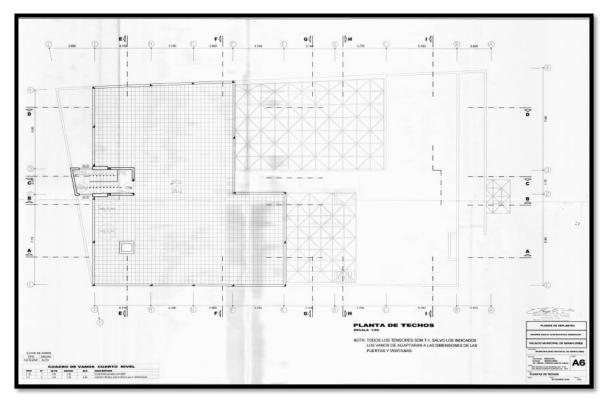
Planta de techos del palacio municipal. Fuente: Propia.
